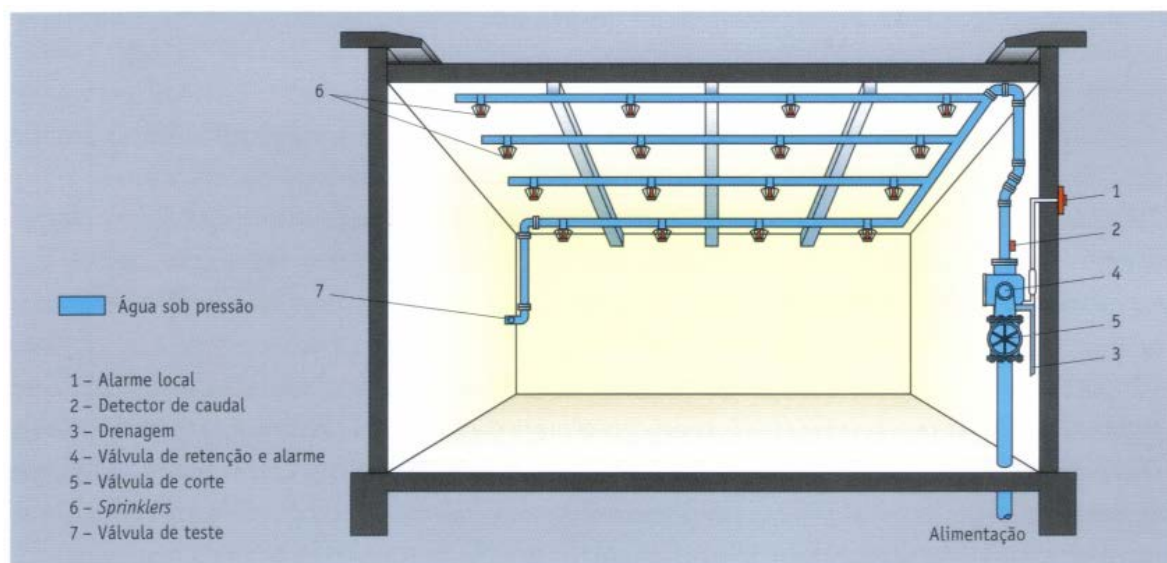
Instalação de sprinklers húmida (wet pipe system) [4].
